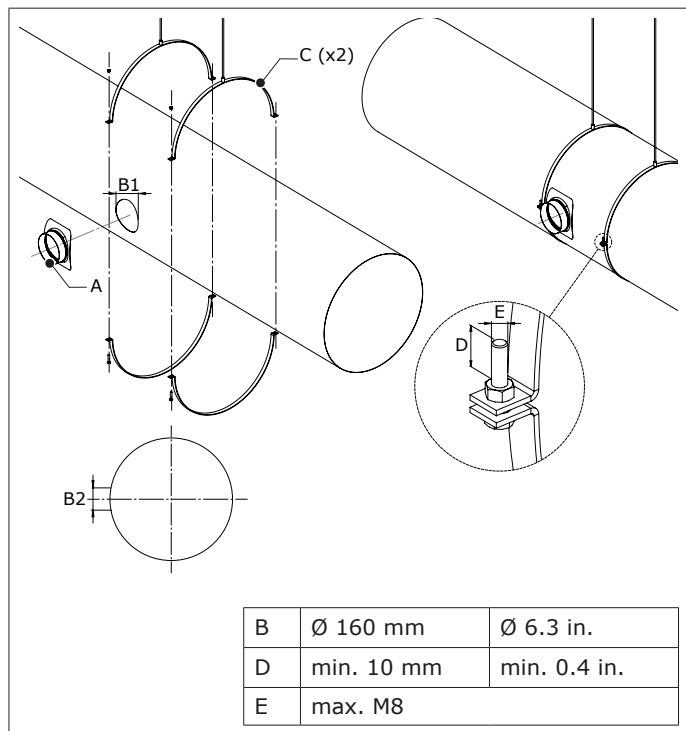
Ondersteuning van het leidingwerk + montage van het zadelstuk
